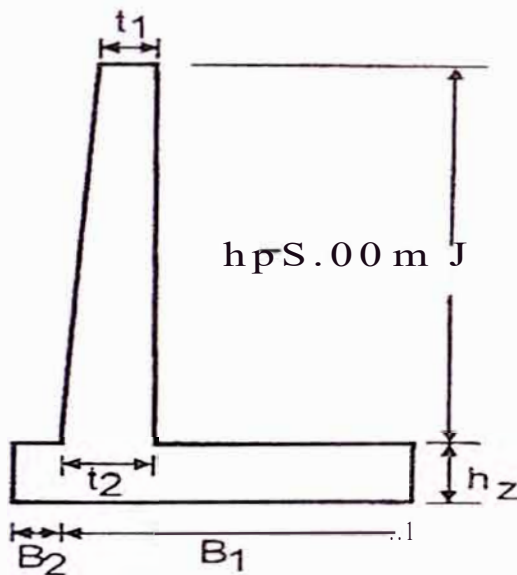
Dimensionamiento del Muro en Voladizo.
